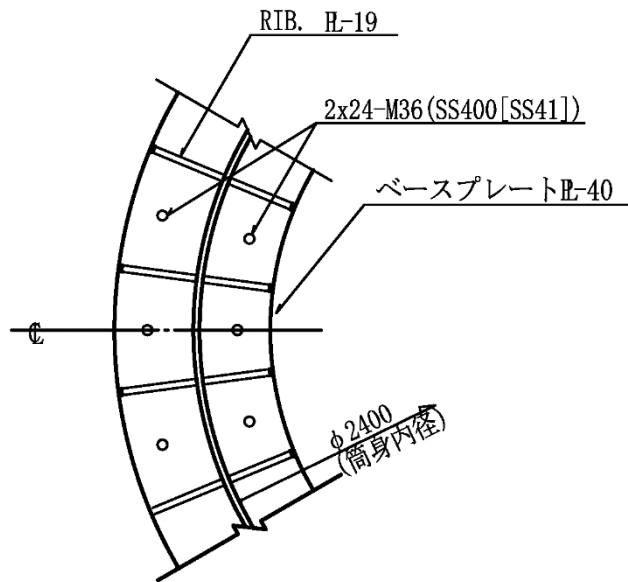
筒身部基礎の詳細図 (単位 : mm)
